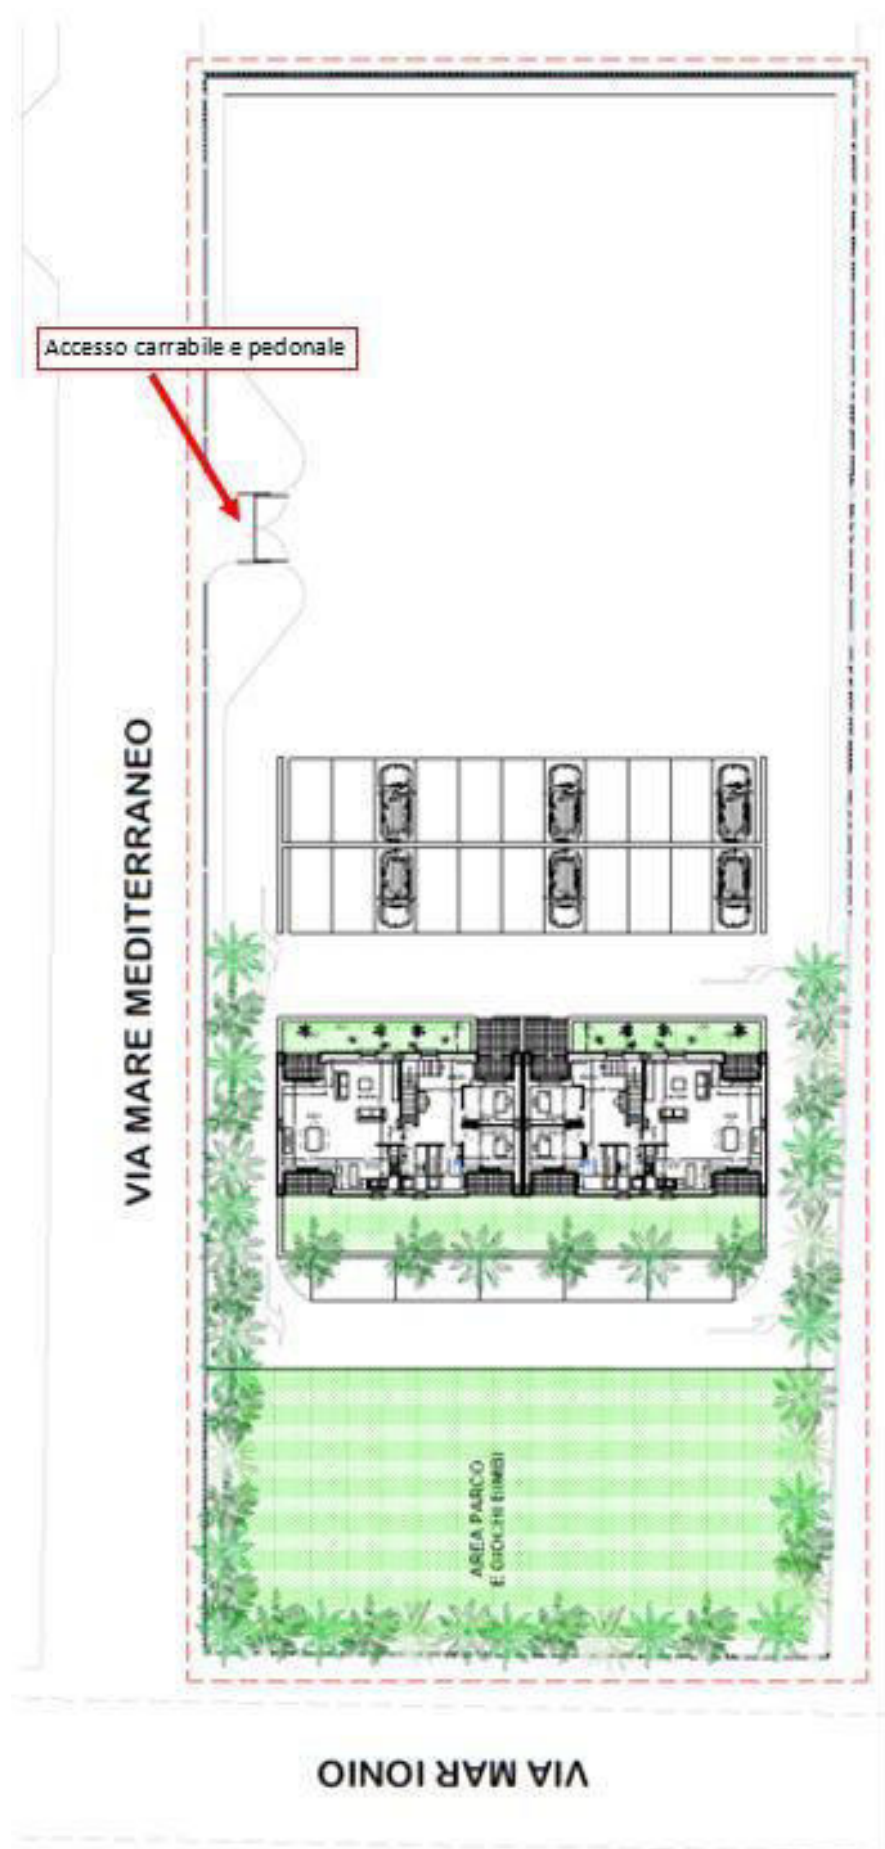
Planimetria dello stato di progetto con indicazione degli interventi previsti e dell'accesso all'area
